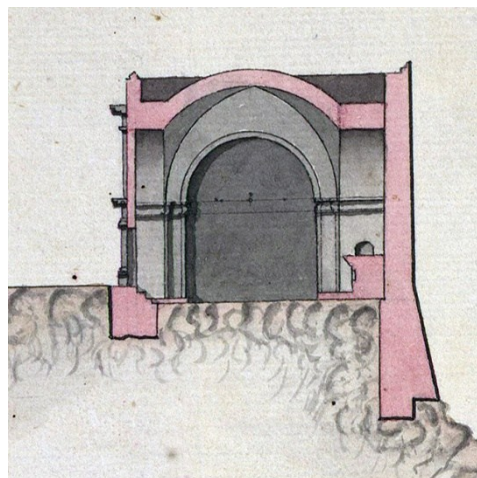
Sección de la capilla de la Santa Cruz, fragmento del *Plano del castillo de Santa Cruz de la plaza de Orán y perfil que pasa por la línea AB. de 1732 con la planta del fuerte*. AGS, MPD 16-063 y MPD 16-064
